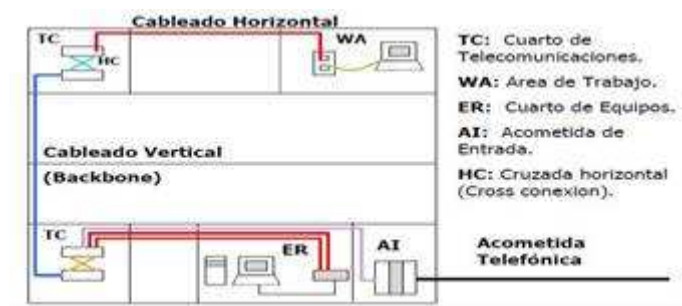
Componentes de Cableado Estructurado ^[4]
